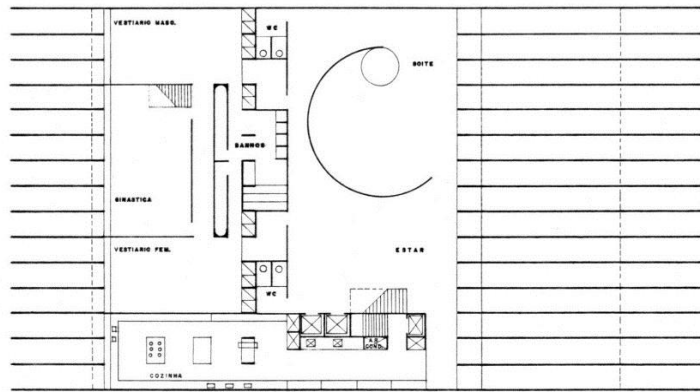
Planta baixa do pavimento térreo do Clube XV (Fonte: ESPALLARGAS, 2016)
